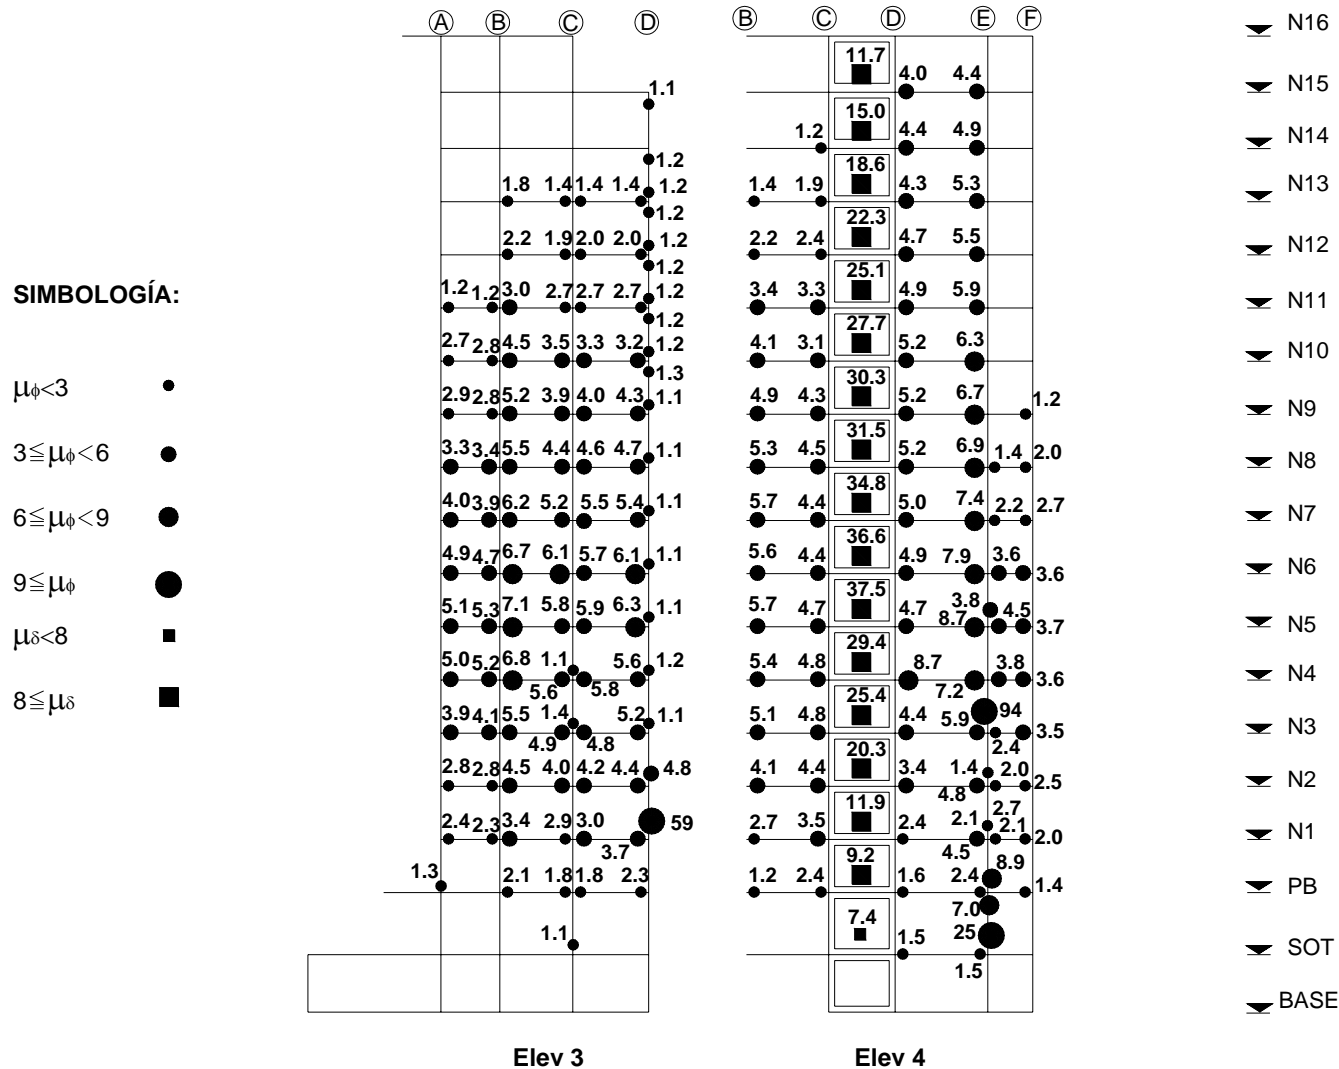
Ductilidades locales máximas de vigas, columnas y muros de concreto reforzado, en las elevaciones 3 y 4, para la SIM64
